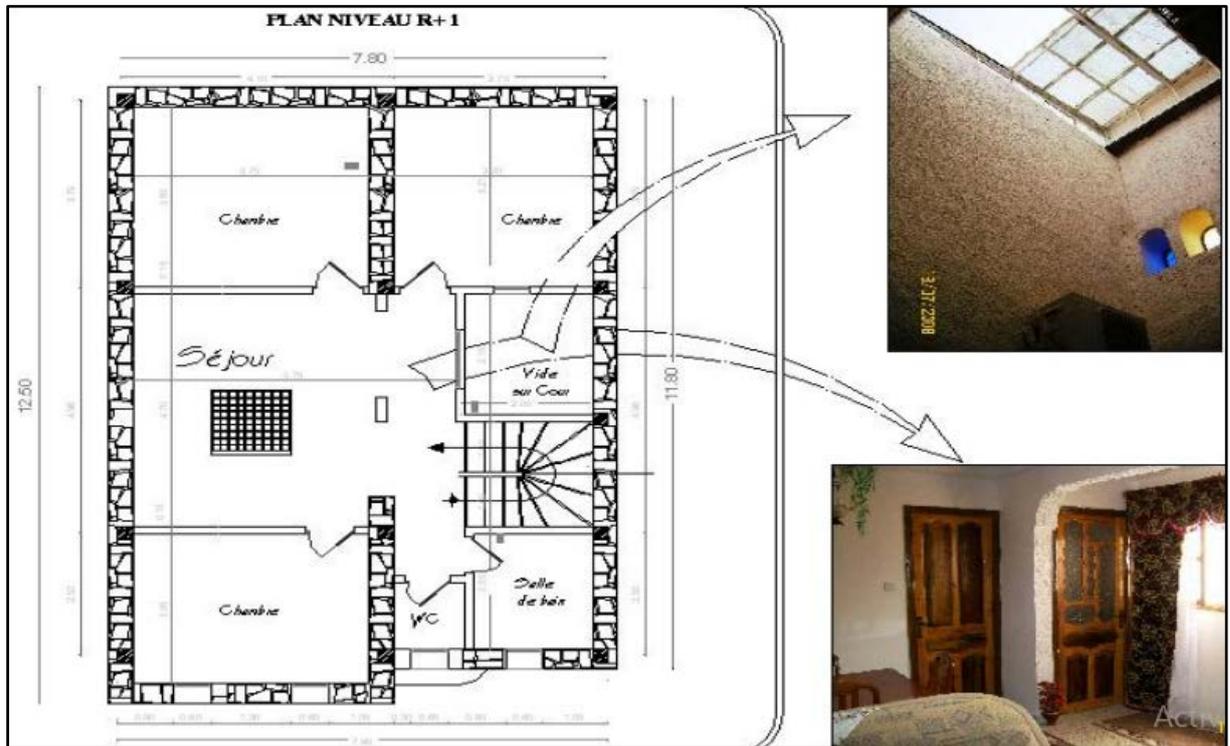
plan d'étage d'une maison de ksar Tafilalet
